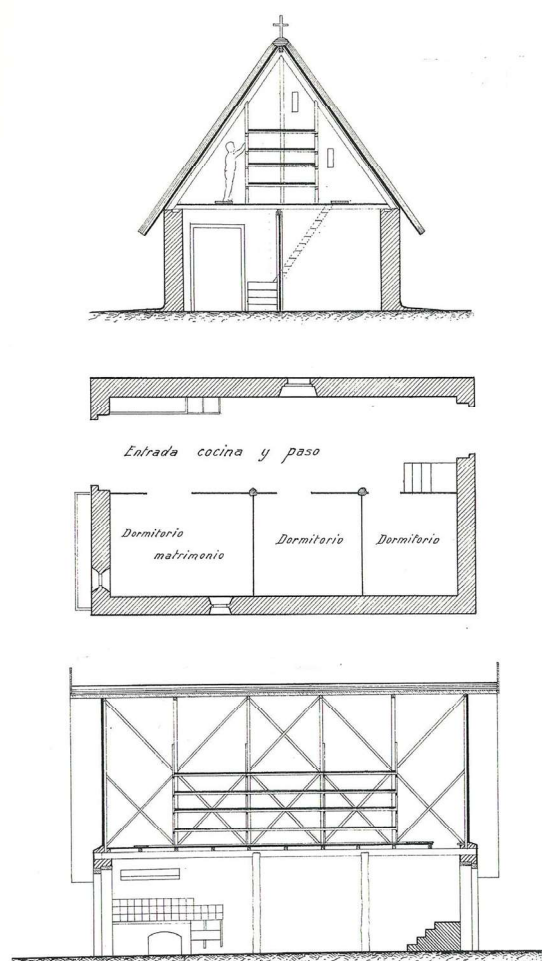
Sección, planta y alzado barraca (Gosálvez, V. [1915]1998, 21)
